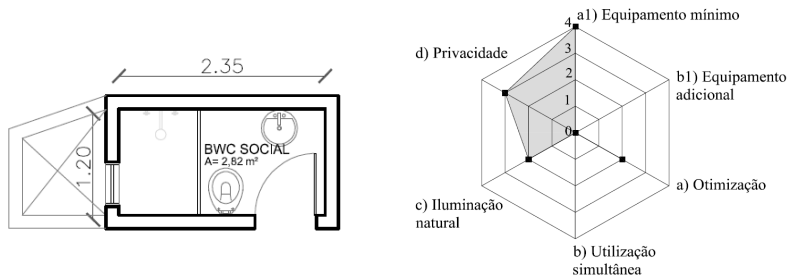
a) Planta baixa banheiro Tipo B. b) Modelo radar do banheiro Tipo B.
